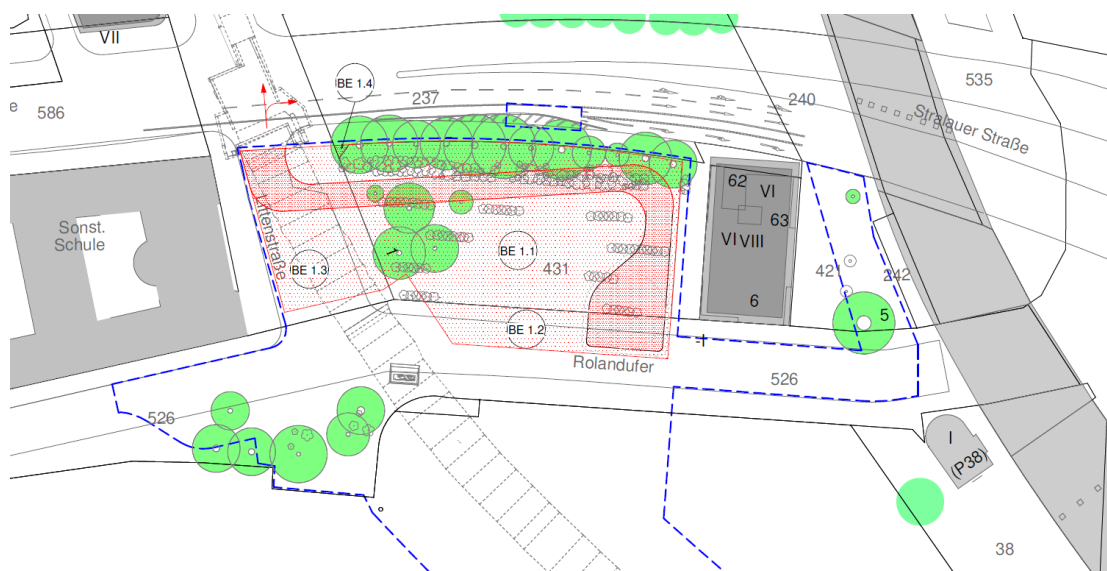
Lageplan zentrale Baustelleneinrichtung Rolandufer
